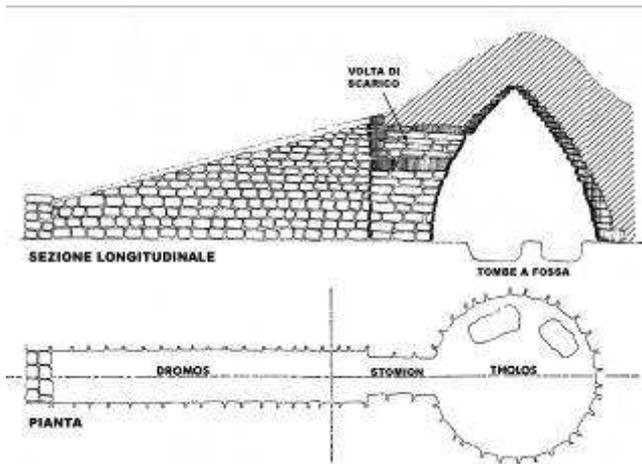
Dendra (Midea). Tomba a tholos. Pianta e sezione longitudinale (MYLONAS 1966)
